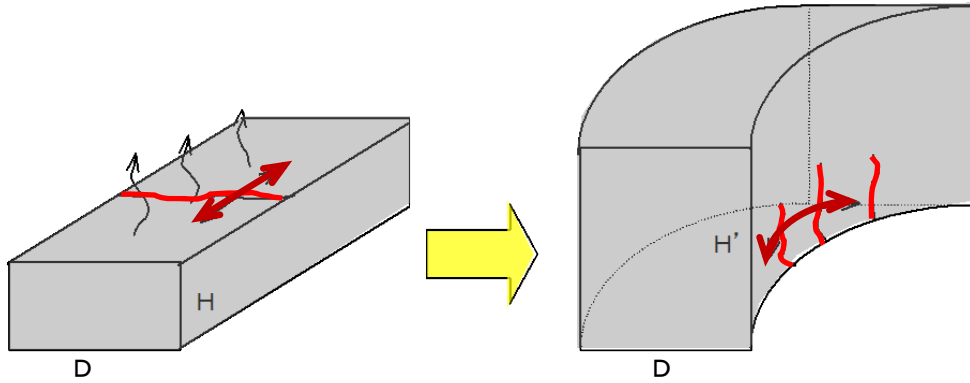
側面放熱の影響によるひび割れ発生の様式図
